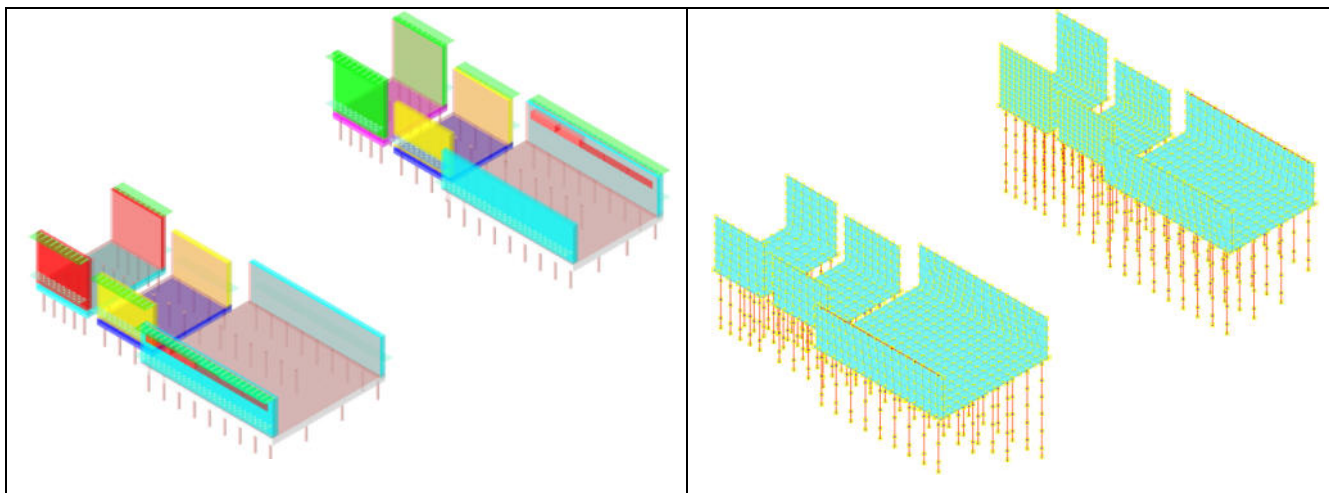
Modelli di calcolo canali fugatori con fondazioni profonde
